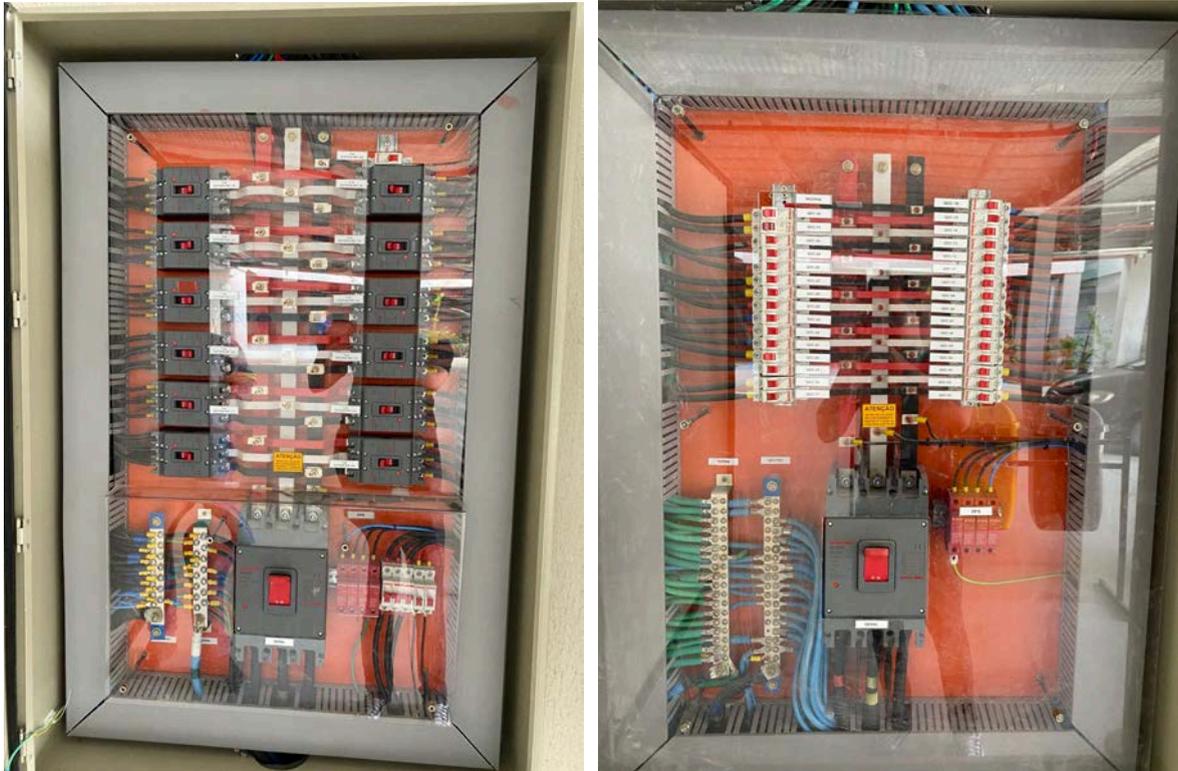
Local de instalação(interno a subestação). Fonte: Autoria Própria.
